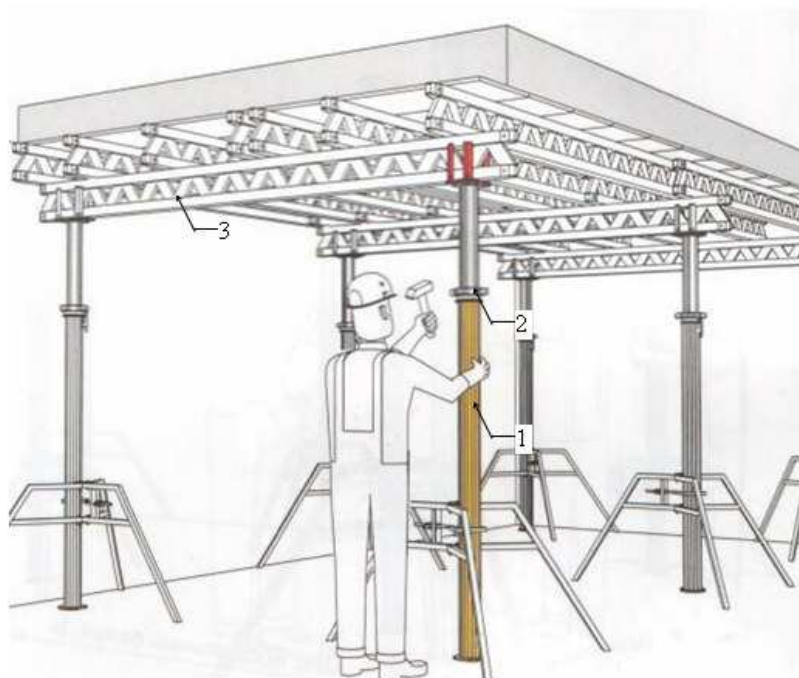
Опускание настила опалубки: 1-основная стойка; 2-регулирующая гайка; 3-продольная балка
